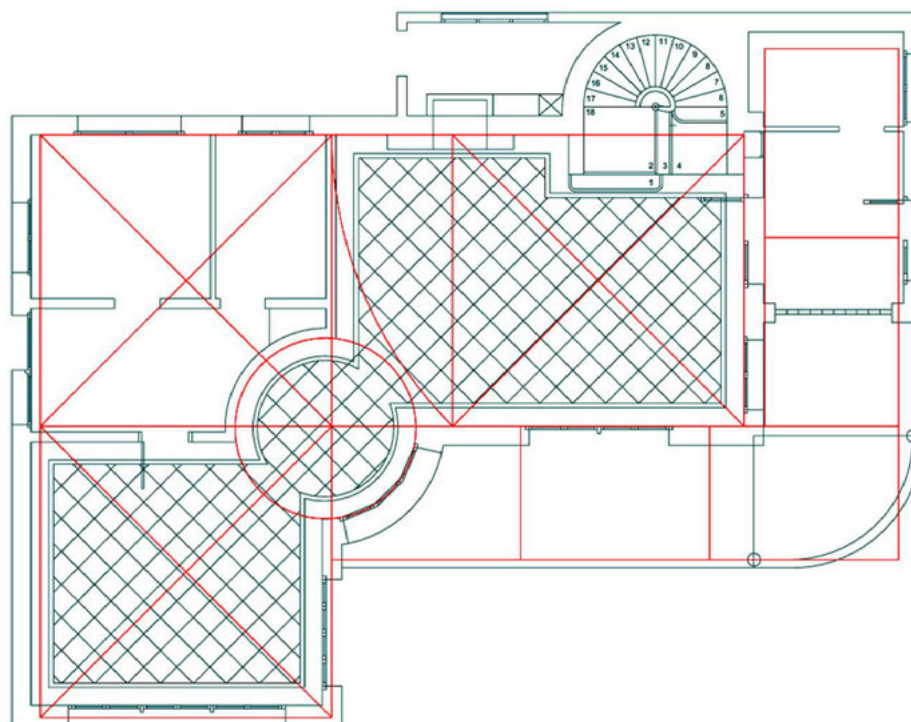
Planimetría de la planta baja actual solapando figuras de proporciones
